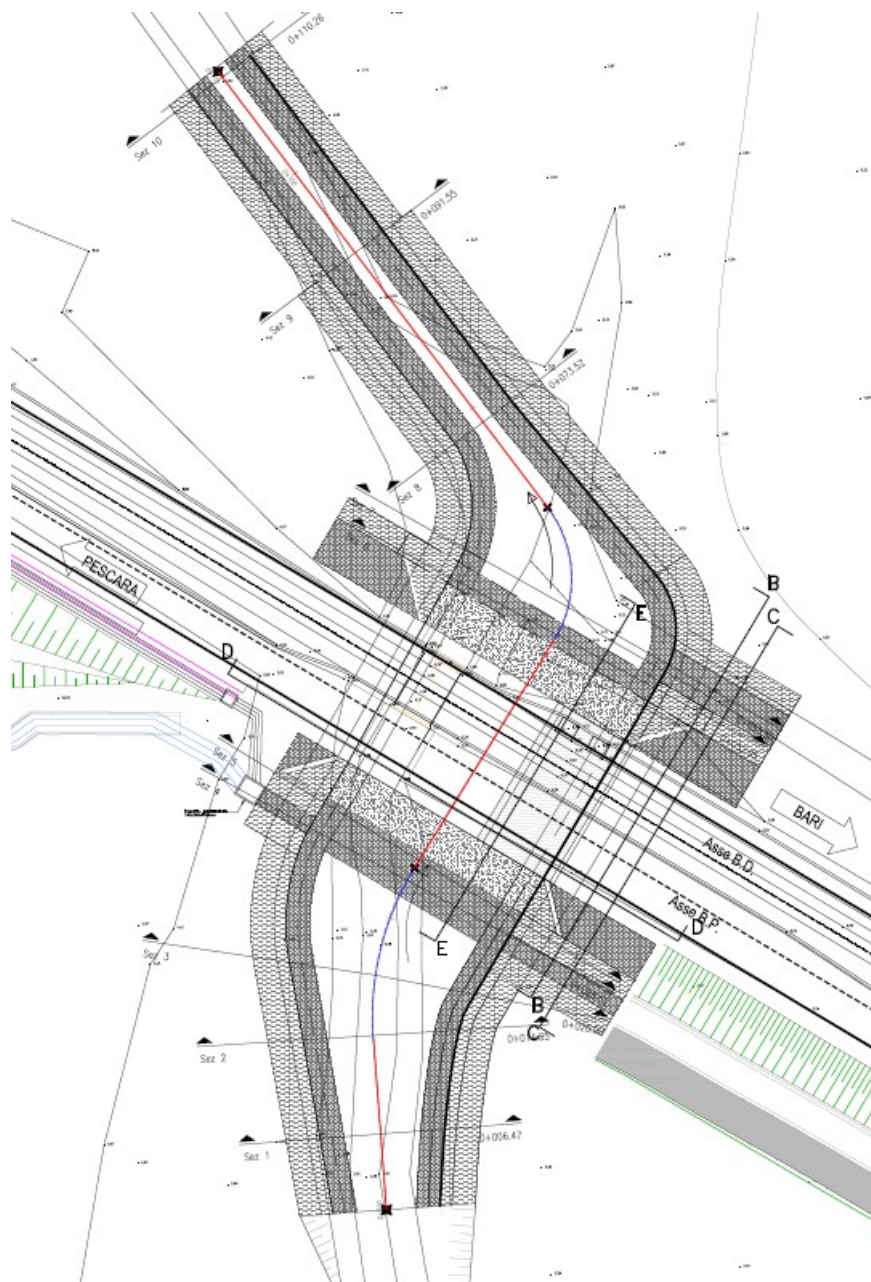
Fosso Olivella 2: planimetria dell'opera di attraversamento in progetto.
